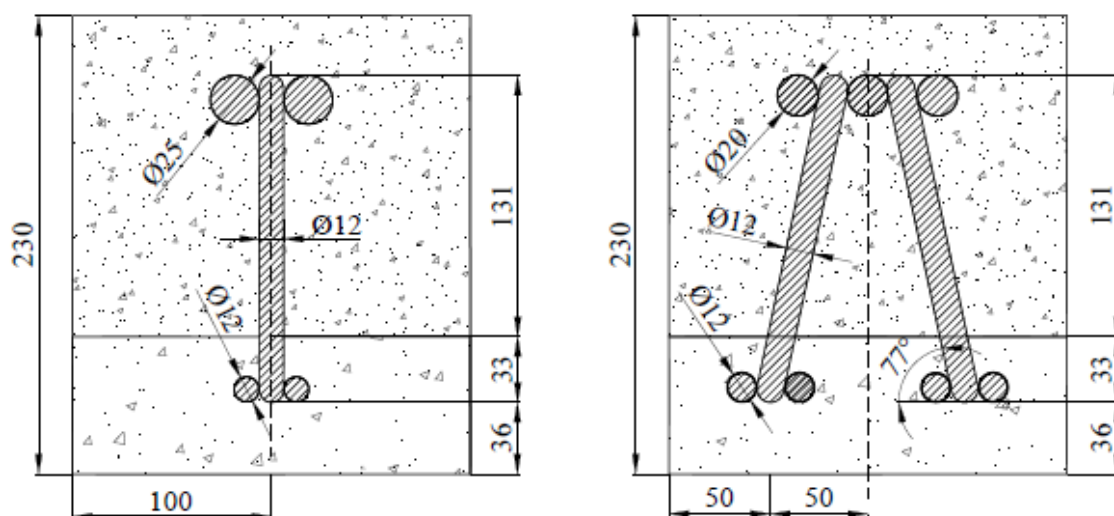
Secciones transversales fase SII, CSTCB Tipo B
